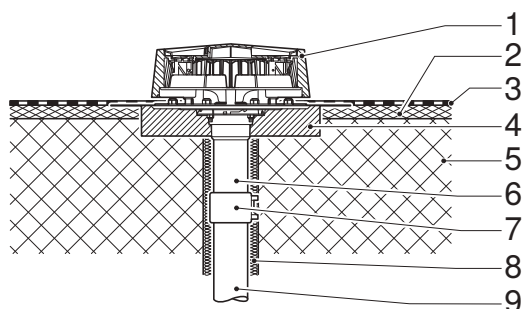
Montage dans toiture massive non isolée avec revêtement d'étanchéité
